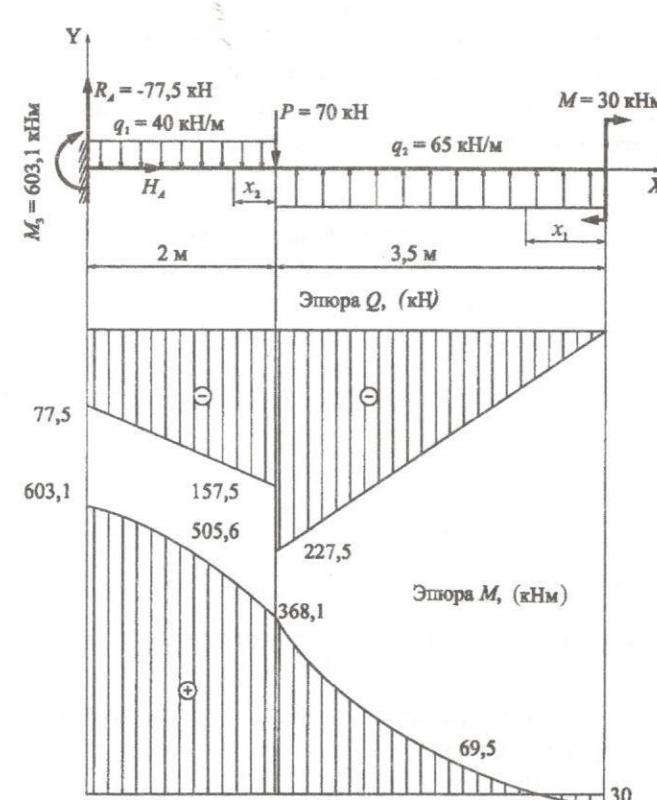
Расчётная схема балки и эпюры внутренних усилий.
